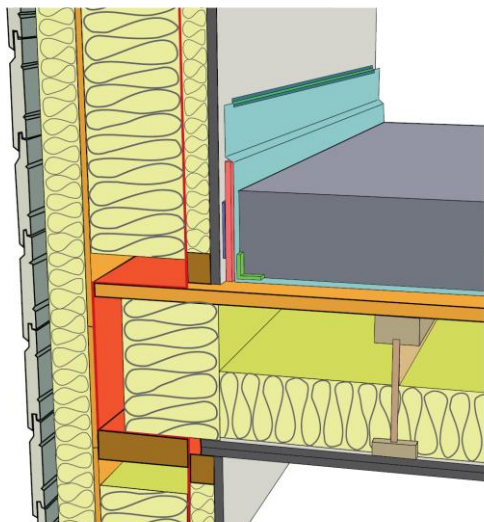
Désolidarisation périphérique entre chape ou dalle sur plancher par solivage poutre en I et mur extérieur ossature bois
